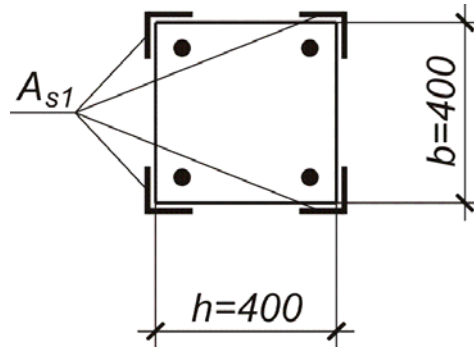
Расчетное сечение колонны, усиленной предварительно напряженными распорками
